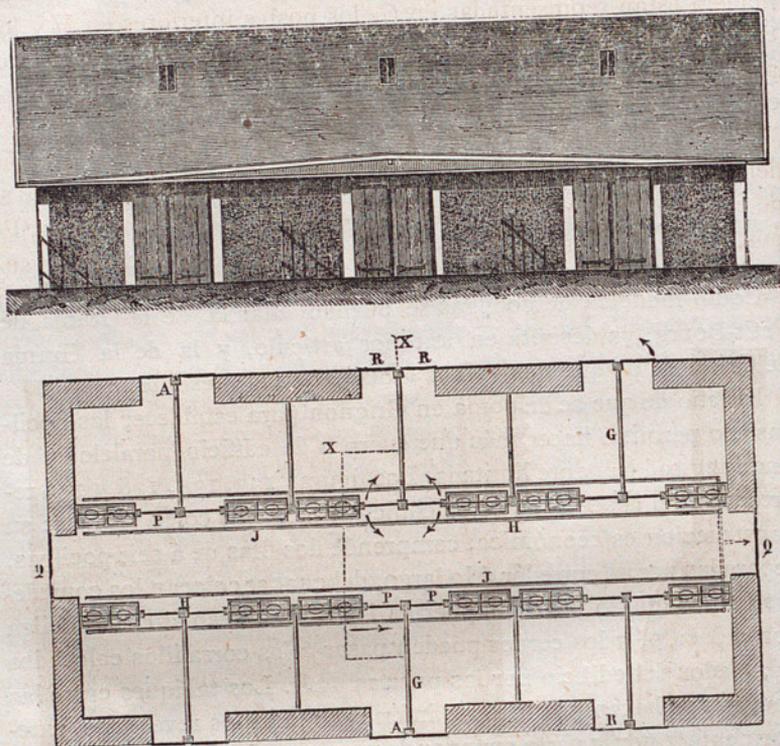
Alzada y plano del conjunto de las pocilgas en Grignon.
